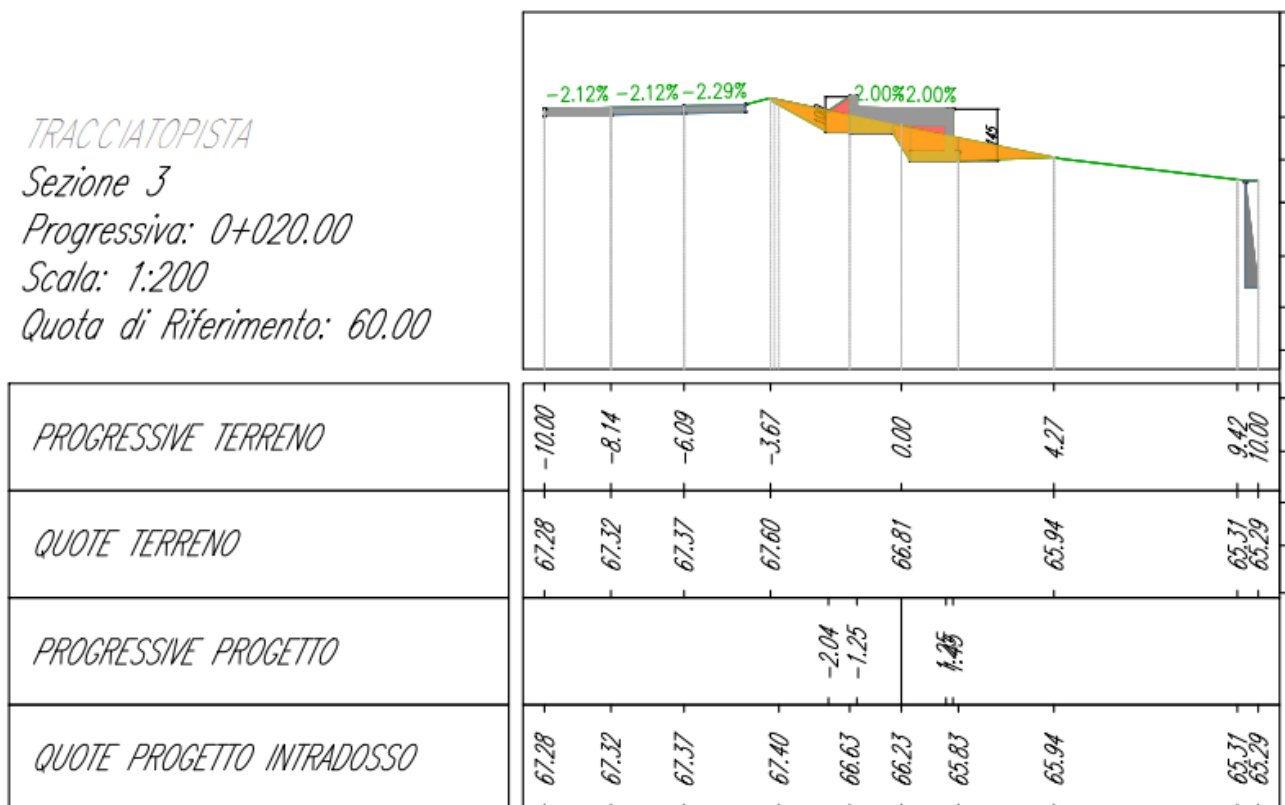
Tratta L3 – Microtratta Naviglio pavese – sezione trasversale n.3
